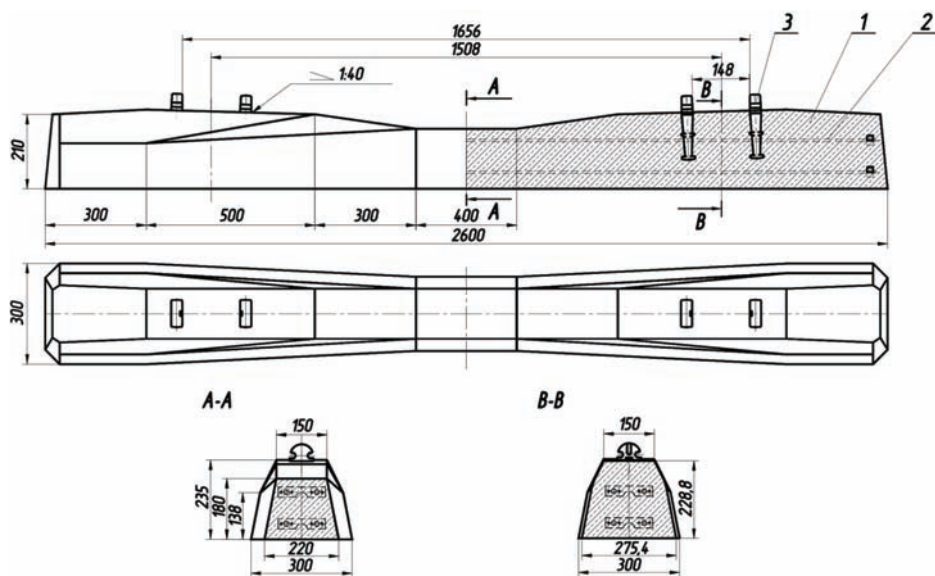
Podkład strunobetonowy PS83/SB dla przytwierdzenia SB [9]
